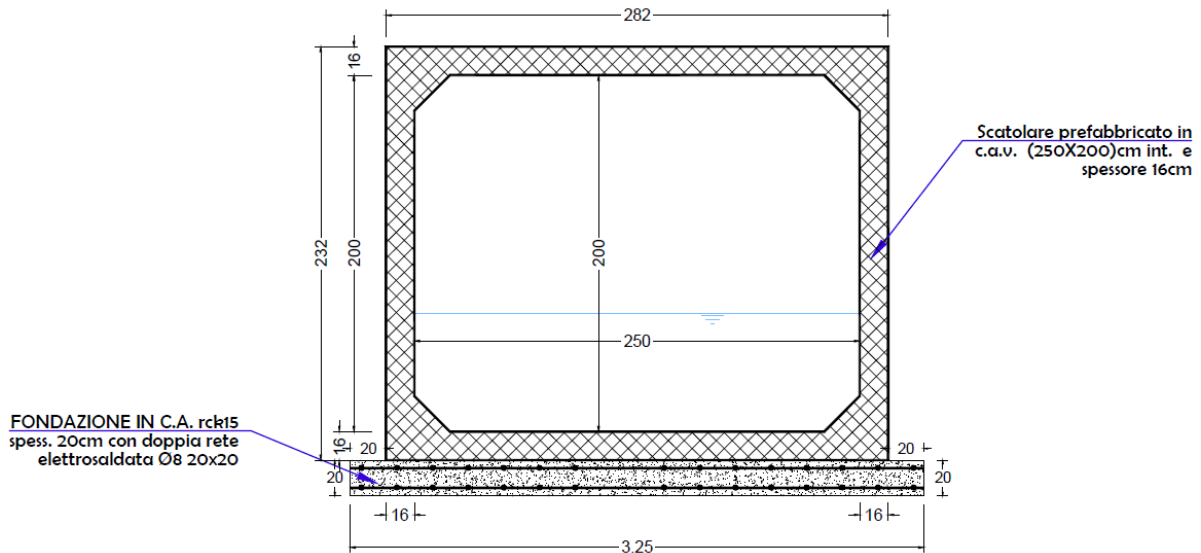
Sezione tipo - Canale a valle del 4 attraversamento
